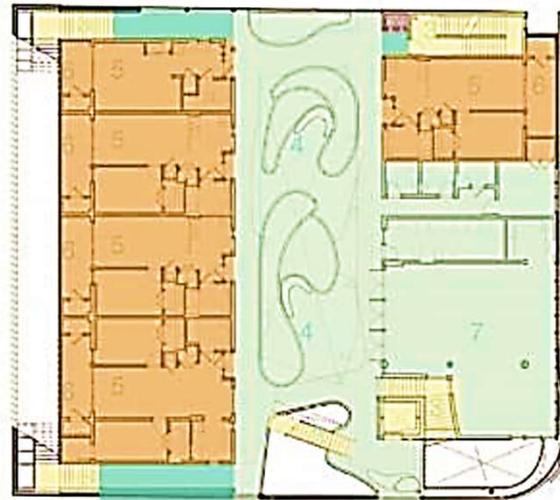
Planta 1º pavimento La Brea | Autor: Patrick Tighe Architecture
